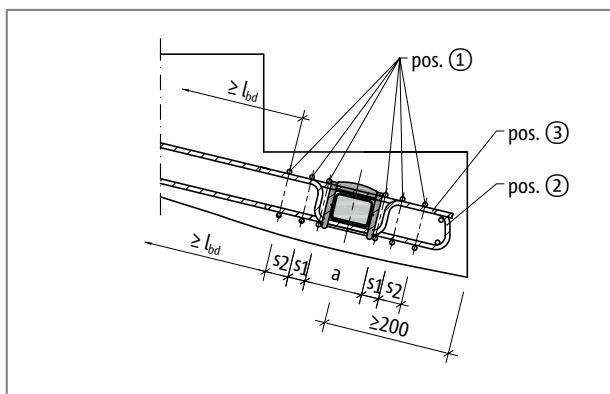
Schöck Tronsole® typ Q: Řez nástupním stupněm
